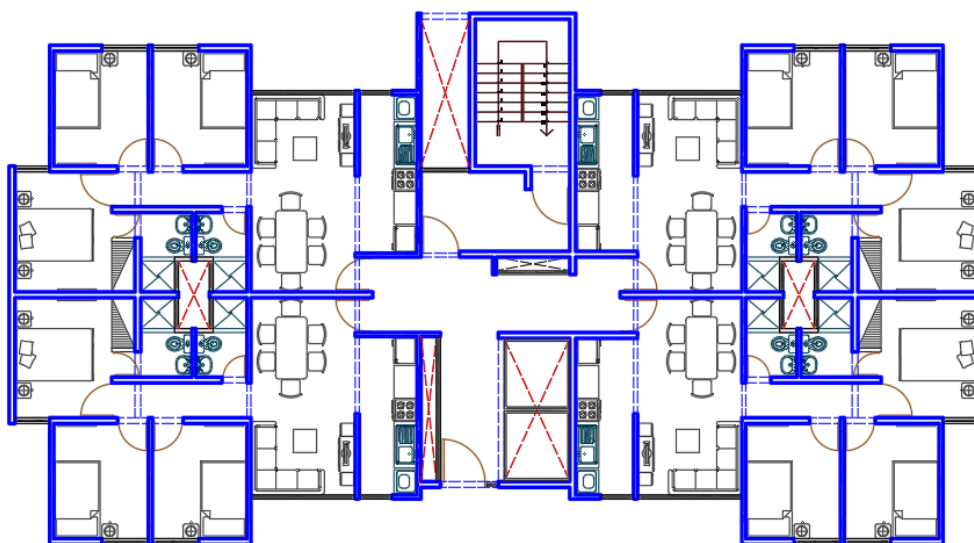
Distribución de Muros para el Sistema MDL – Edificio Blesser. Fuente: Elaboración Propia.
